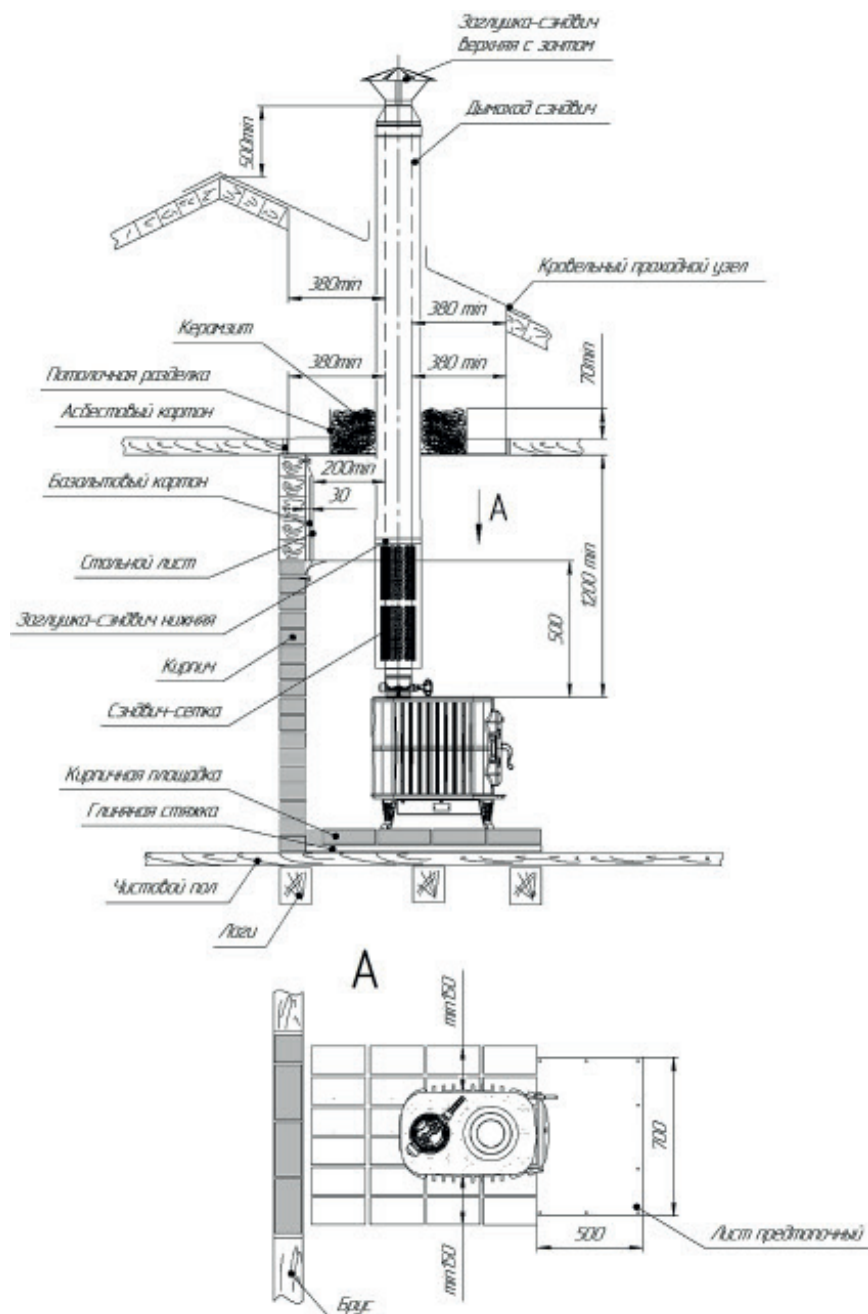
Схема установки печи с кирпичной кладкой (монтаж дымоборника сверху)
